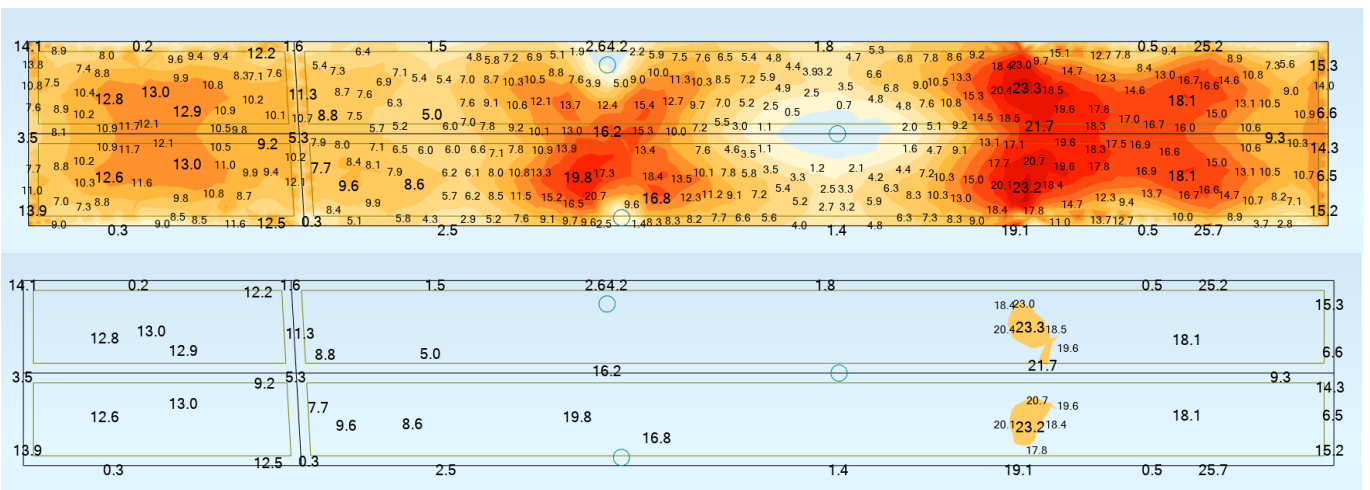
Armadura inferior transversal (abajo zona reforzada)
